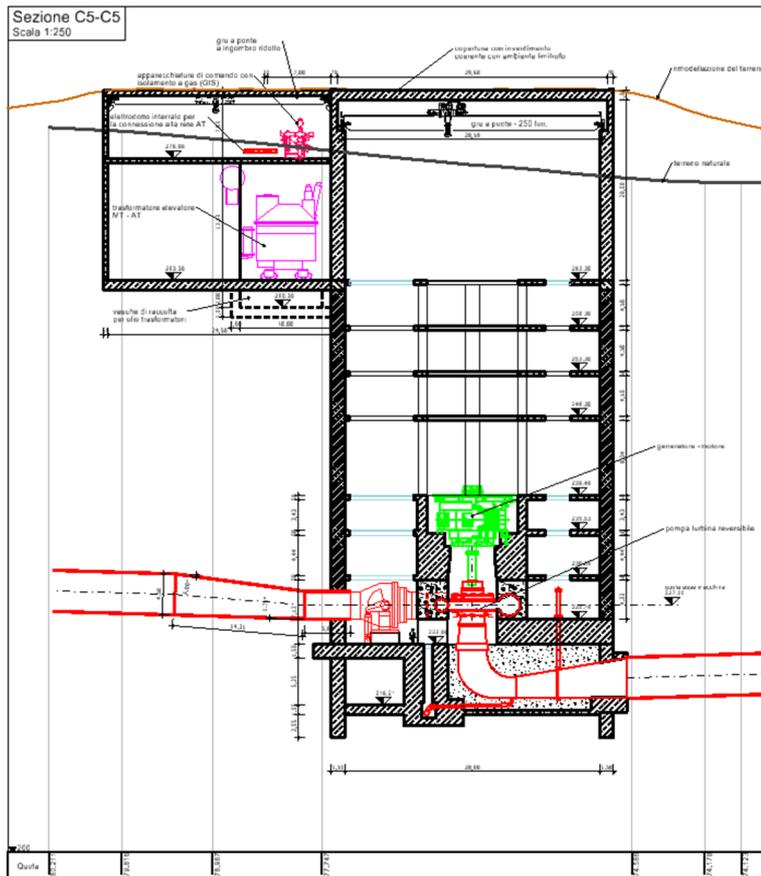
Sezione dell'edificio di centrale (estratto Tav. PD-EP.18.3 del Progetto Definitivo).
